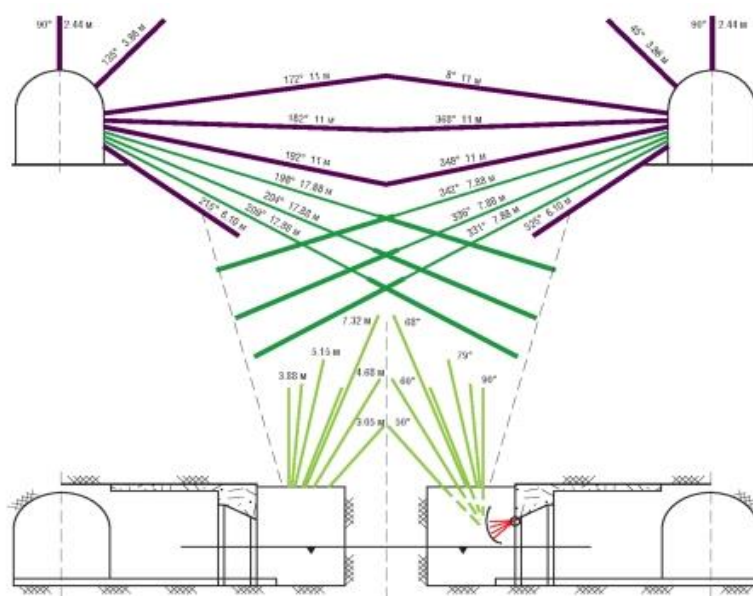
Образование выпускных выработок и формирование подсечки на руднике Хендерсон
